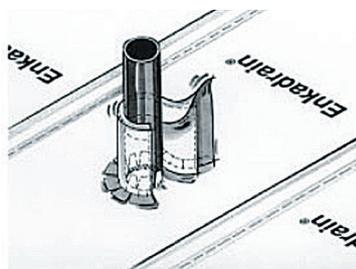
Сопряжение Enkadrain® с вентиляционным выходом
